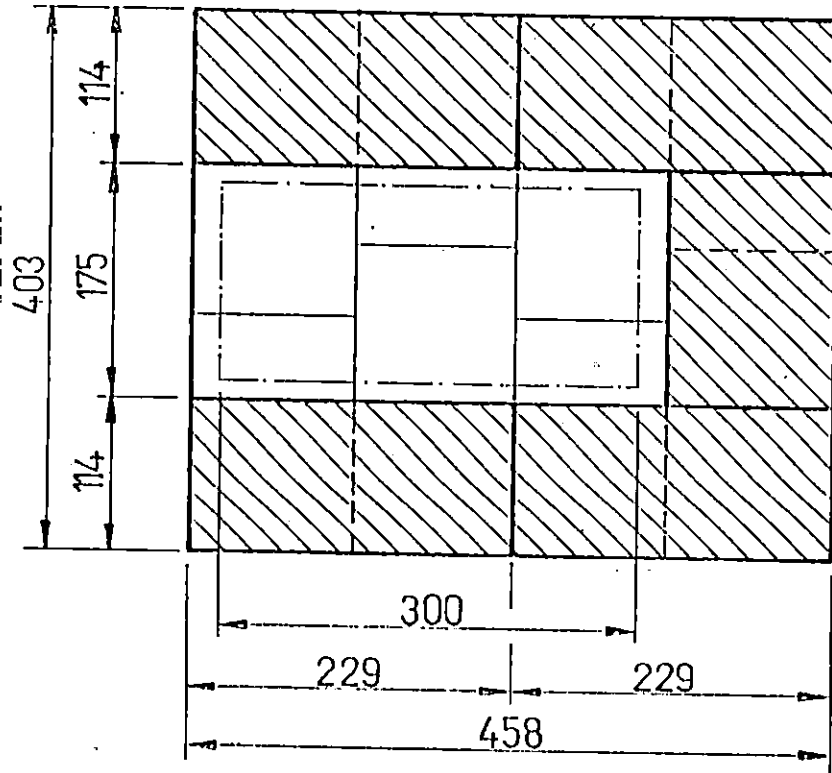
Sección en planta de paredes de la cámara de trabajo del horno.
